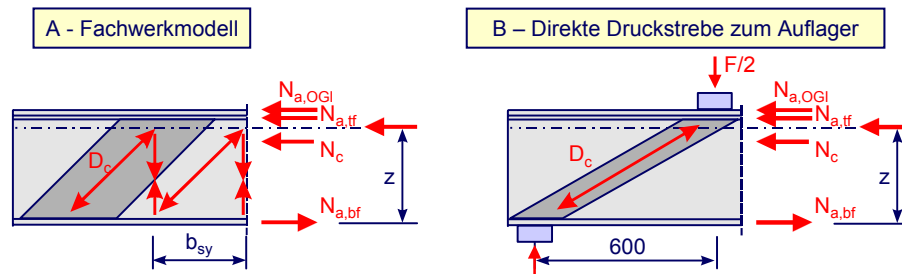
Ausbildung der Betondruckstrebe – Träger SF-BT-U3 [54]
